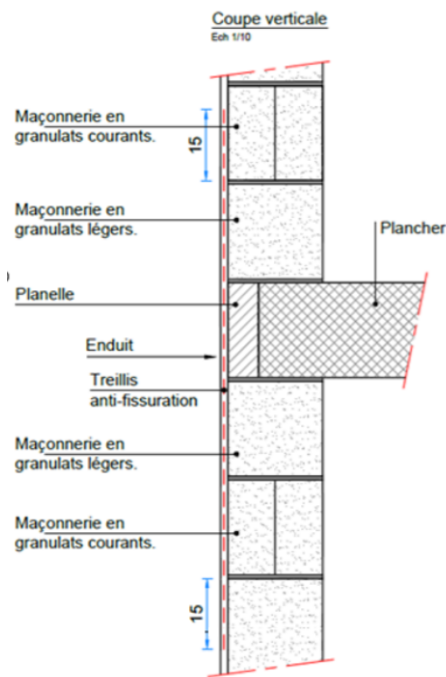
Revêtement extérieur : Renfort d'enduit au niveau du plancher
